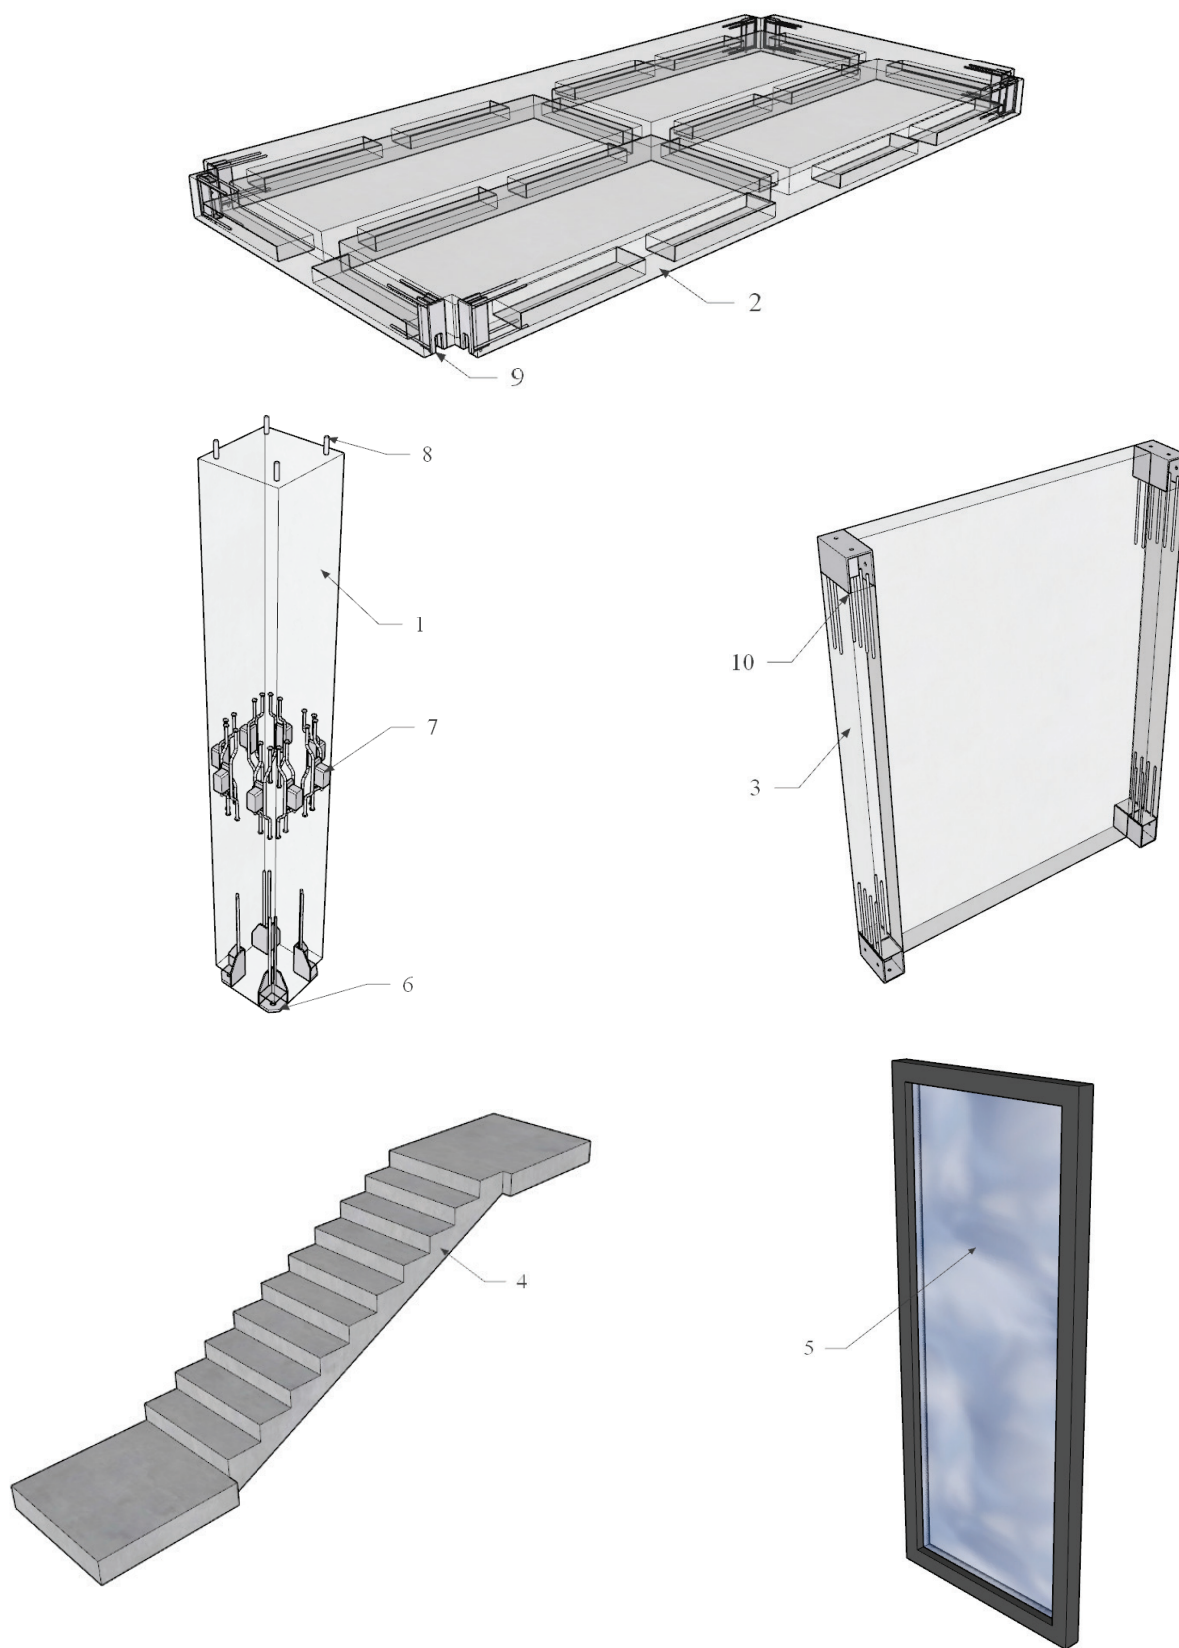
Элементы высокотехнологичной каркасной системы полносборных зданий (1 — колонна, 2 — плита перекрытия, 3 — стеновой блок, 4 — лестничная марш-площадка, 5 — фасадный модуль, 6 — опорный башмак колонны, 7 — опорная консоль колонны, 8 — выпуски арматуры, 9 — опорный элемент плиты перекрытия, 10 — закладная деталь стенового блока)
